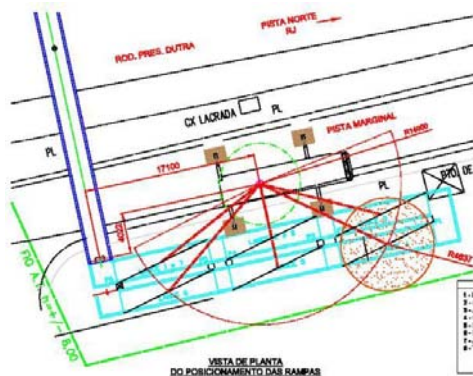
Parte do Plano de *Rigging* utilizado na obra D
